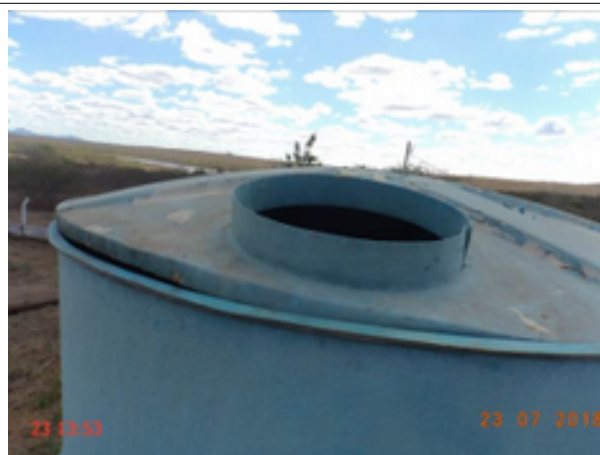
Filtração (Sede): As tampas dos filtros F-1 e F-2 não permitem vedação
